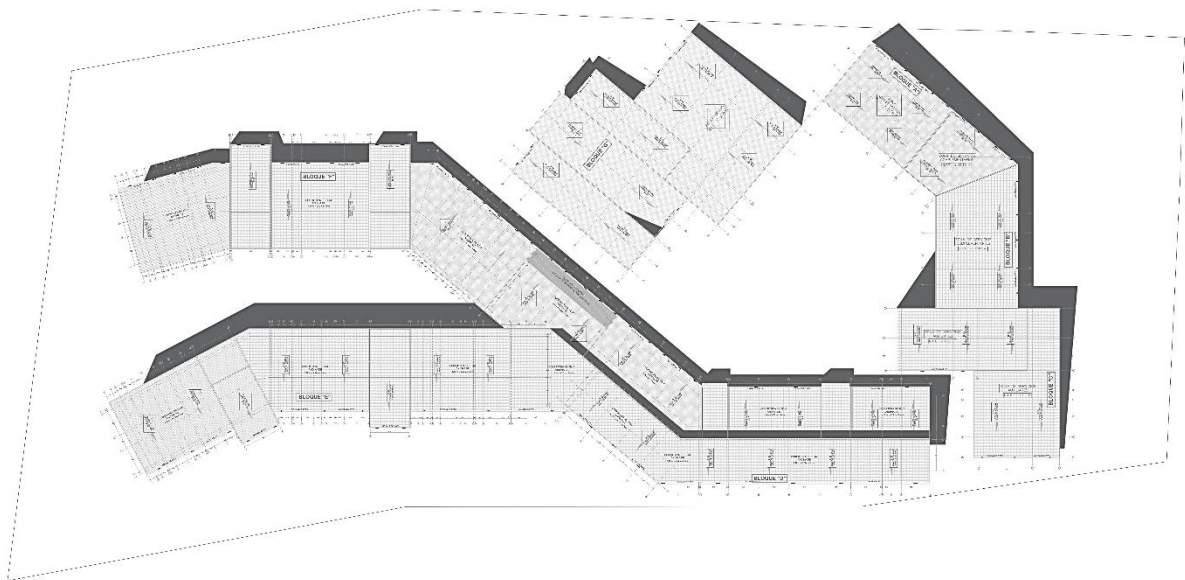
Planteamiento del conjunto- Plano de Cubiertas
